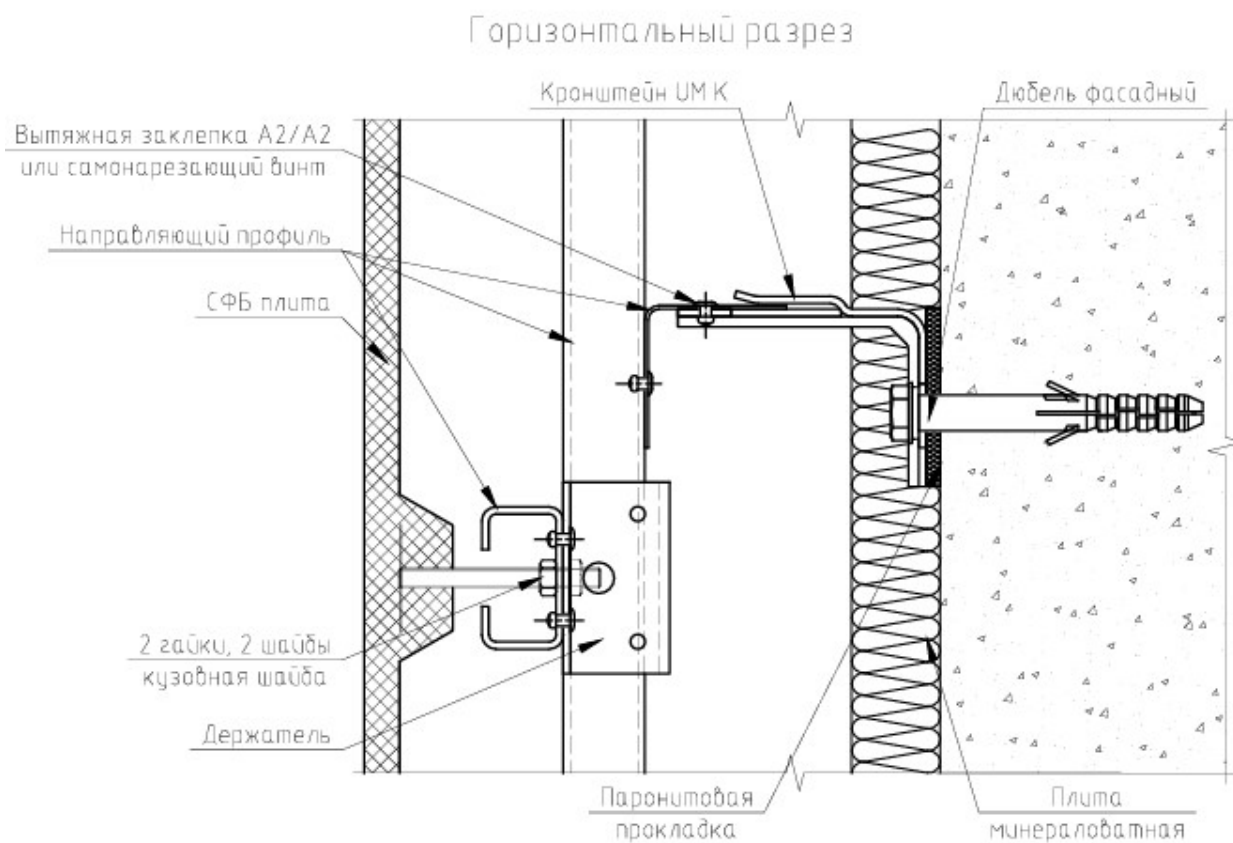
Крепление облицовки с помощью закладных деталей с резьбовой шпилькой к зацепу НФС
